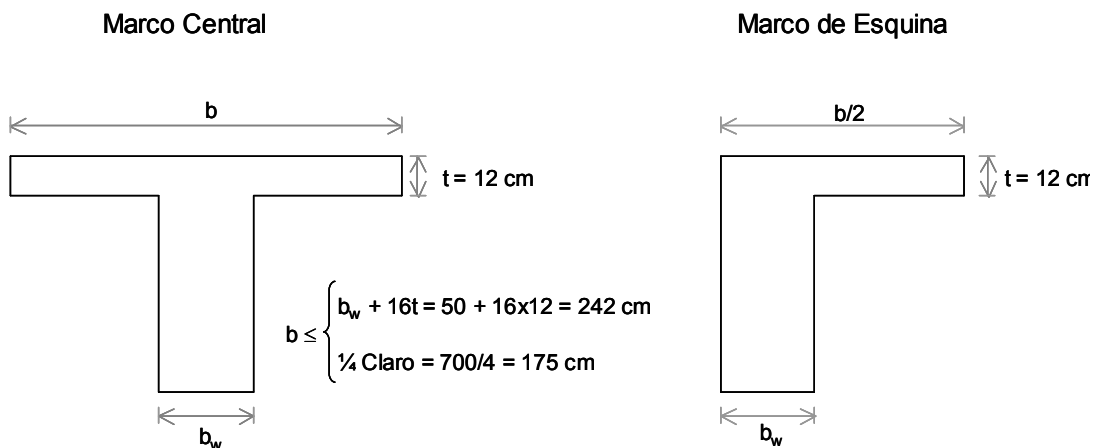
Ancho tributario de losa para determinar la rigidez a flexión de las vigas
